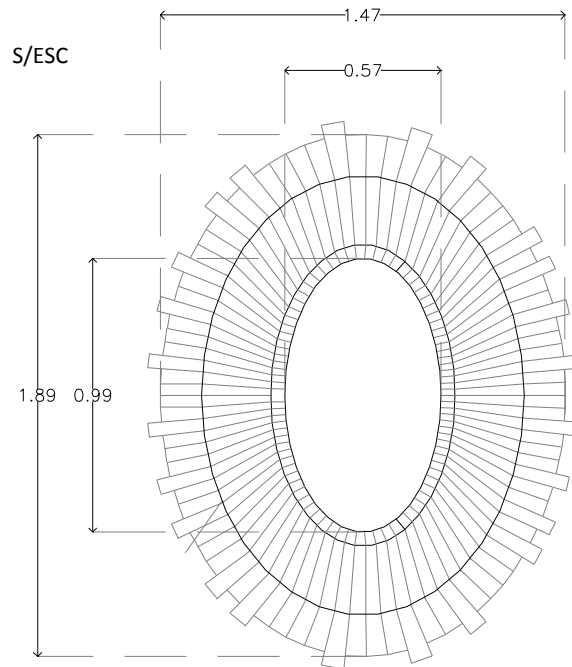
Dibujo arquitectónico, Reconstrucción detalle estado original vano ovalado ojo de buey ornamentado radialmente de ladrillo.
